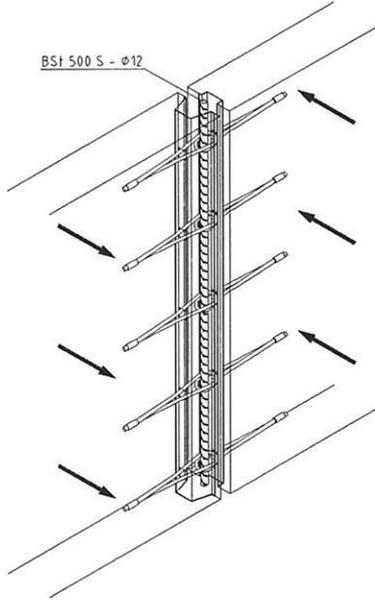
Beanspruchung senkrecht zur Fugenlängsrichtung und Wandebene
